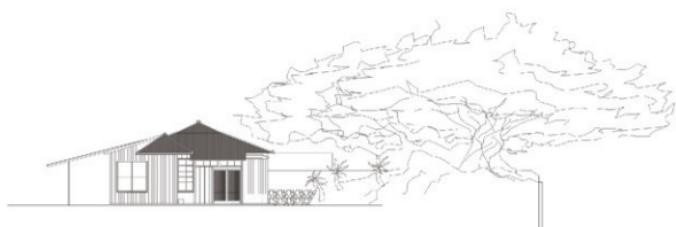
平石一郎邸住宅 南西側立面図 S:1/250
